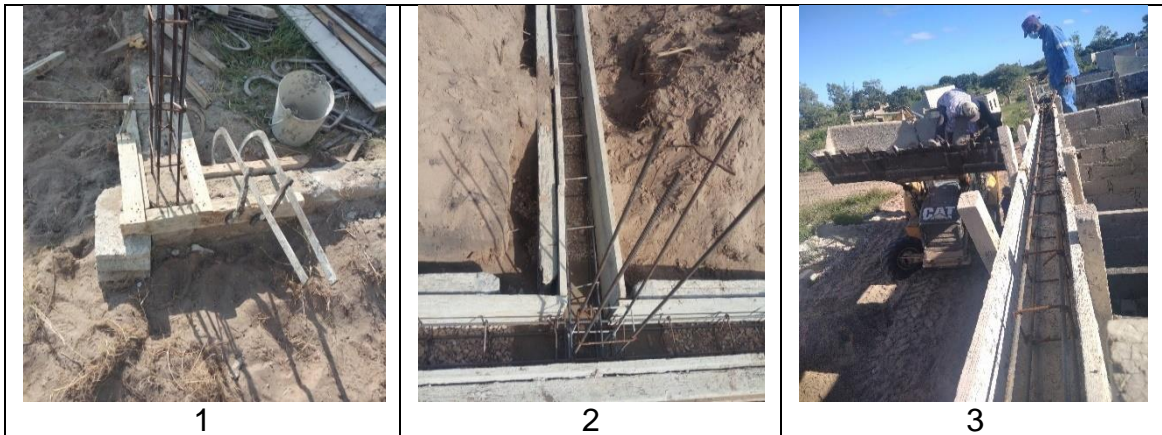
1-Amarração da armadura do pilar, 2-Colocação da armadura da viga de fundação e 3- Colocação da viga de coroamento. (Fonte: autor)
